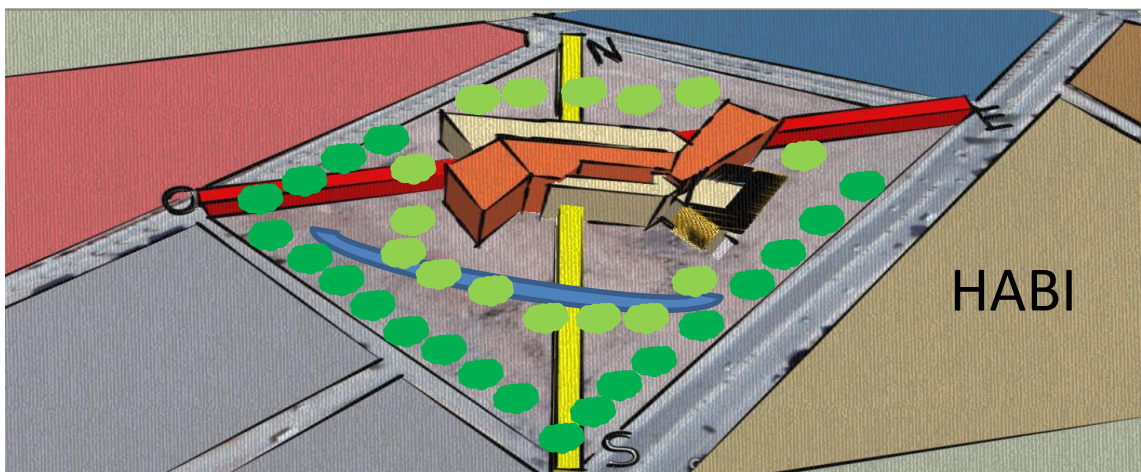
implantation et conception de l'espace extérieur. Source : auteur
